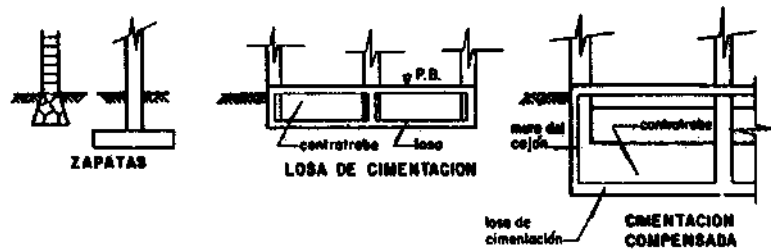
Estructura de cimentación de la Lotería Nacional
